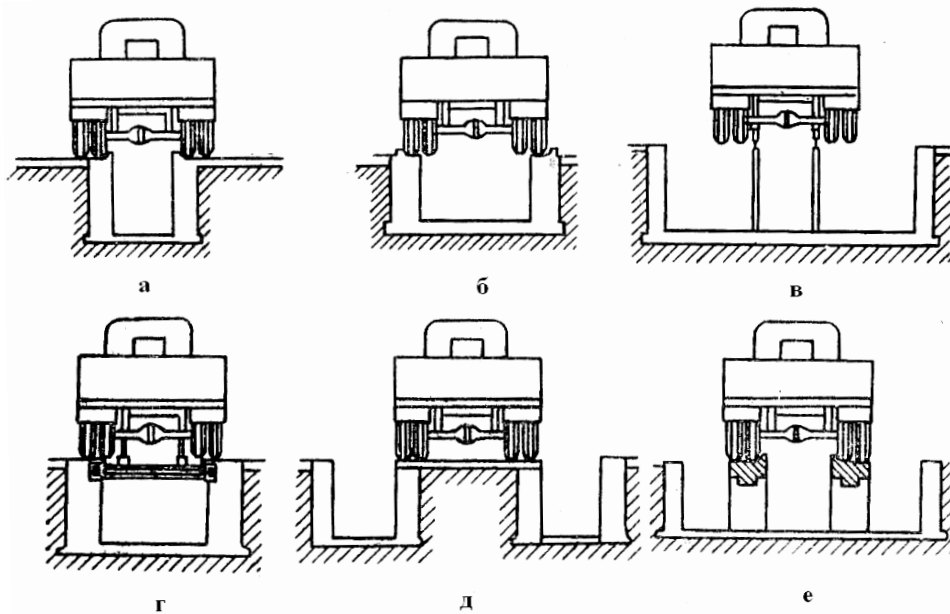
Схемы осмотровых канав: а – межколейная с внутренними ребрами; б – межколейная с наружными ребрами; в – широкого типа; г – безребордная; д – боковая; е – колеяный мост
